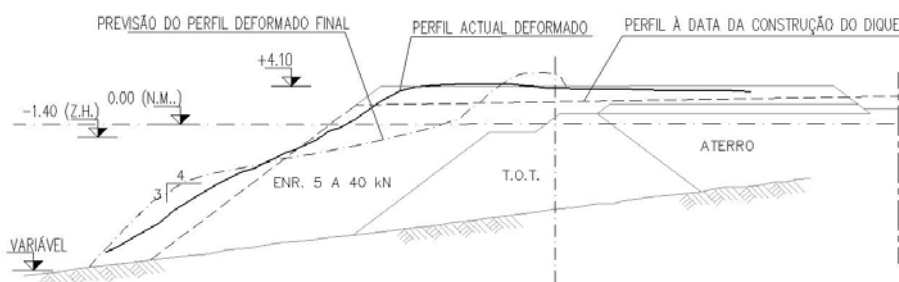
Perfil tipo do Aterro e seu dique de protecção
